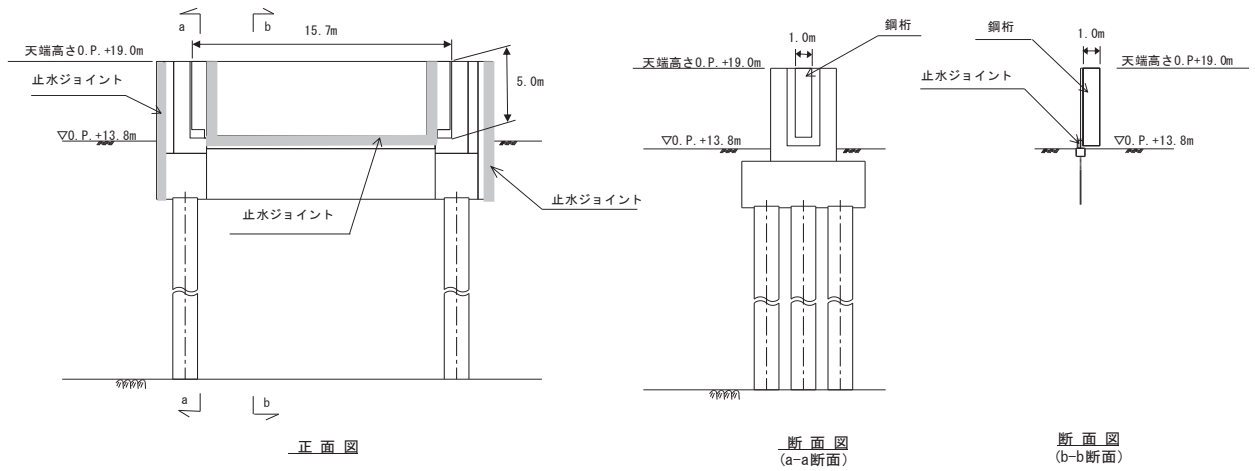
鋼製遮水壁（鋼桁3） 正面図及び断面図
